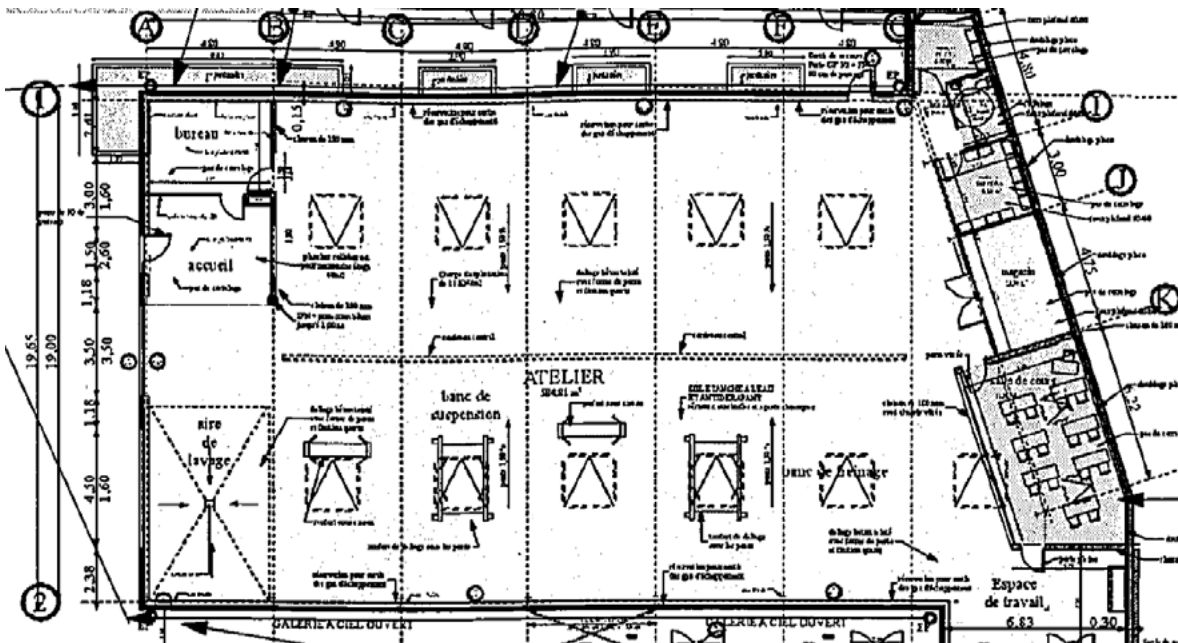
Plan de masse de l'atelier de mécanique.
